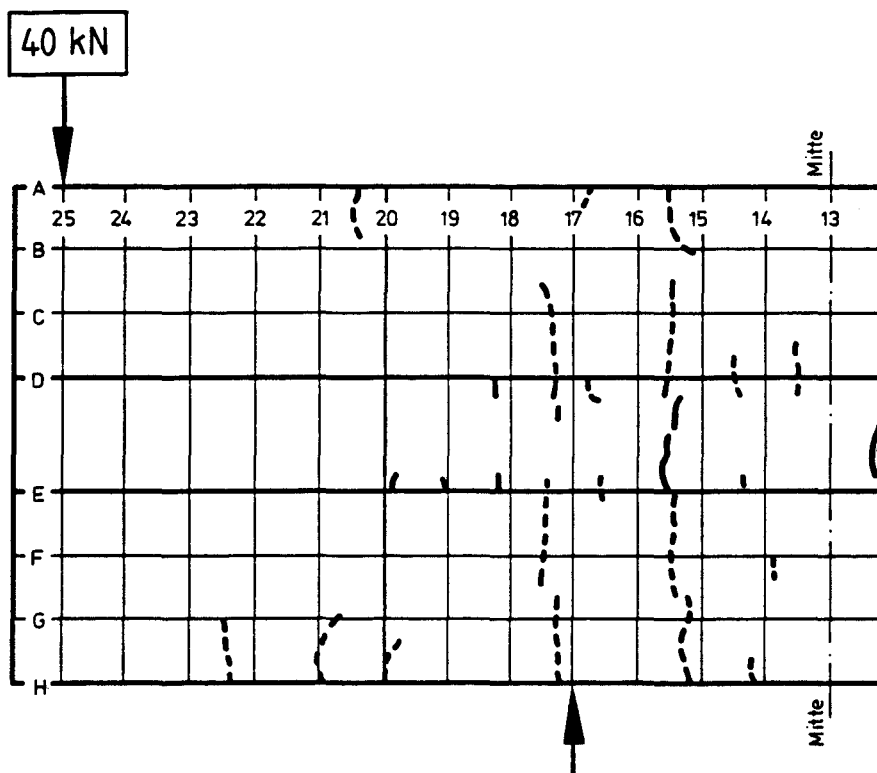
Rißbild unter Gebrauchslast, Ergänzung mit Normalbeton
